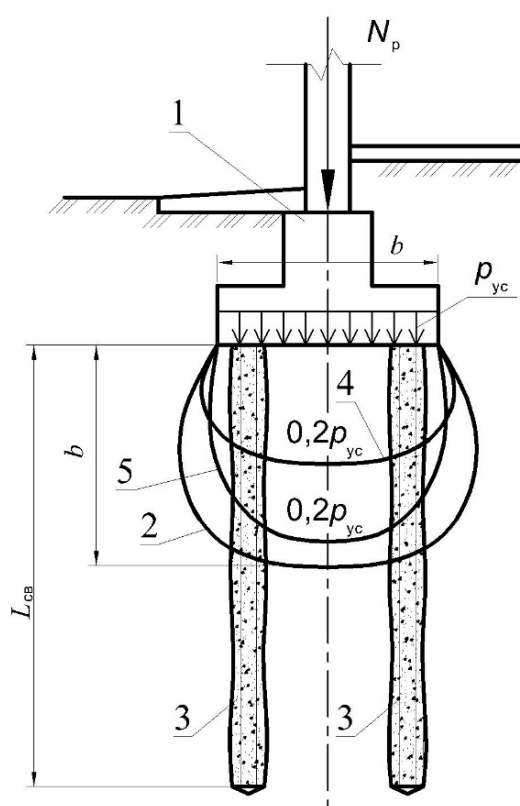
Схема изобар в глинистом грунте под подошвой усиленного фундамента:
